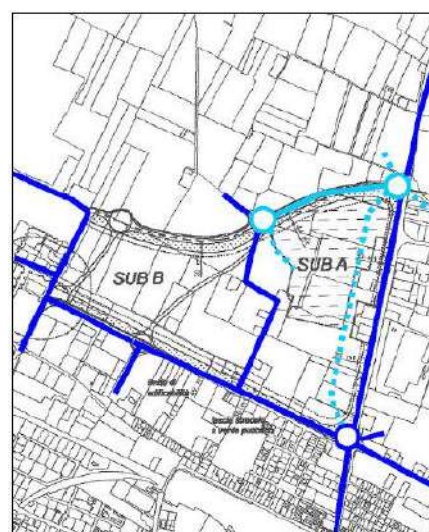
Immagine planivolumetrica di progetto e della rete stradale.
